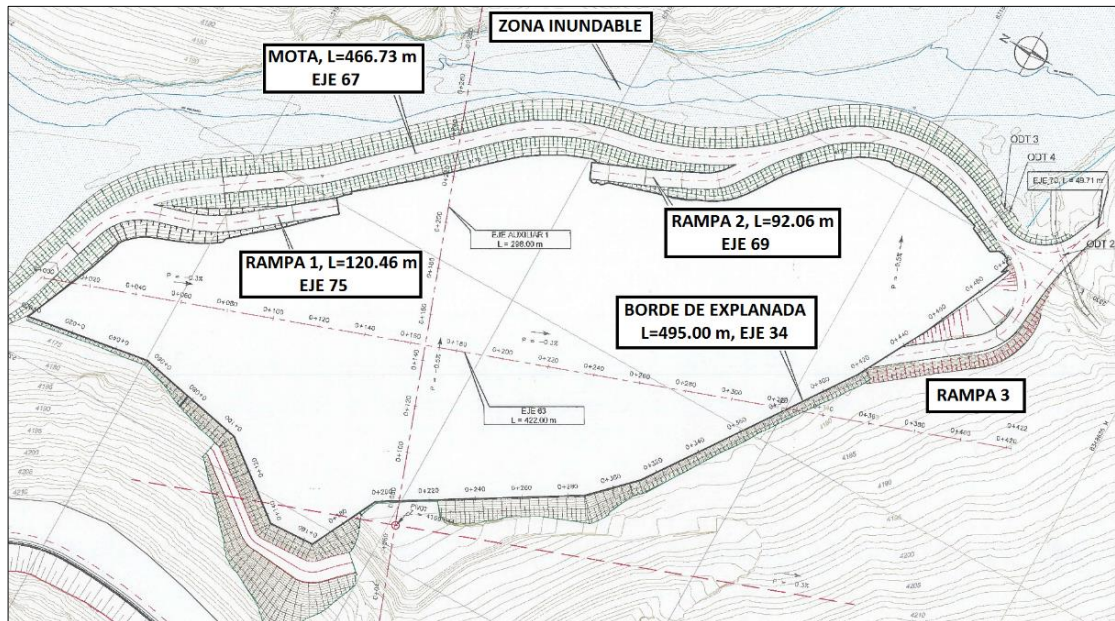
Vista en planta de la plataforma Chalhuanca y mota para protección ribereña
